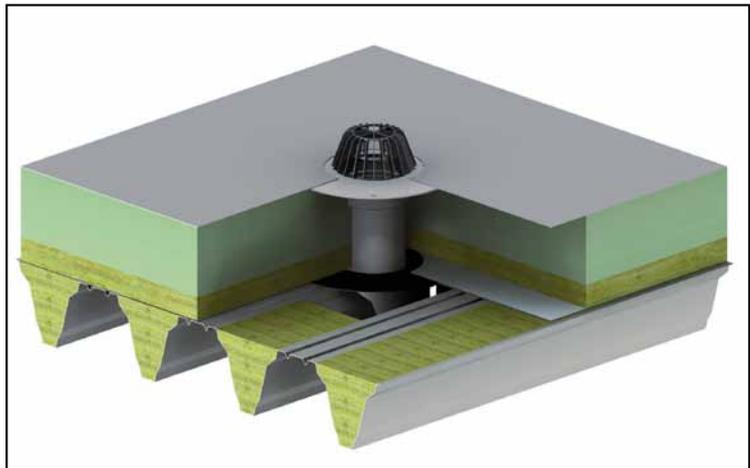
Flachdachabläufe für die Entwässerung von Stahltrapezdächern sind Bauteildurchdringungen, über die sich Brände von unten über brennbare Wärmedämmungen und Dachabdichtungen ausbreiten können. Ein Brandschutzelement schottet den Flachdachaufbau gegen Brandlasten ab.
